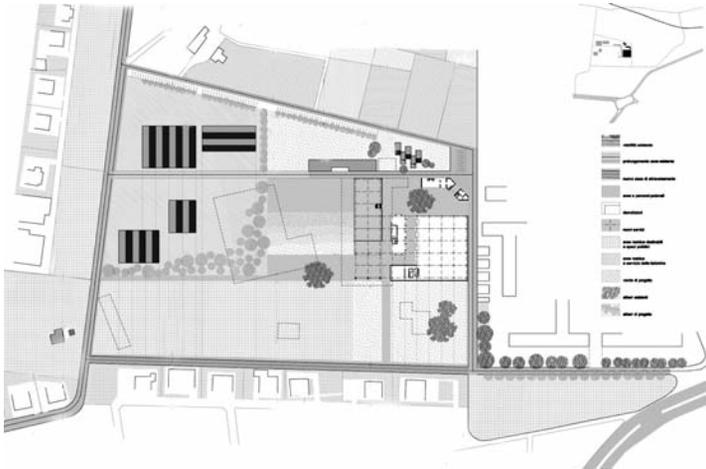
Planimetria generale dell'area dismessa intorno alla fabbrica (piano degli interventi di progetto)
